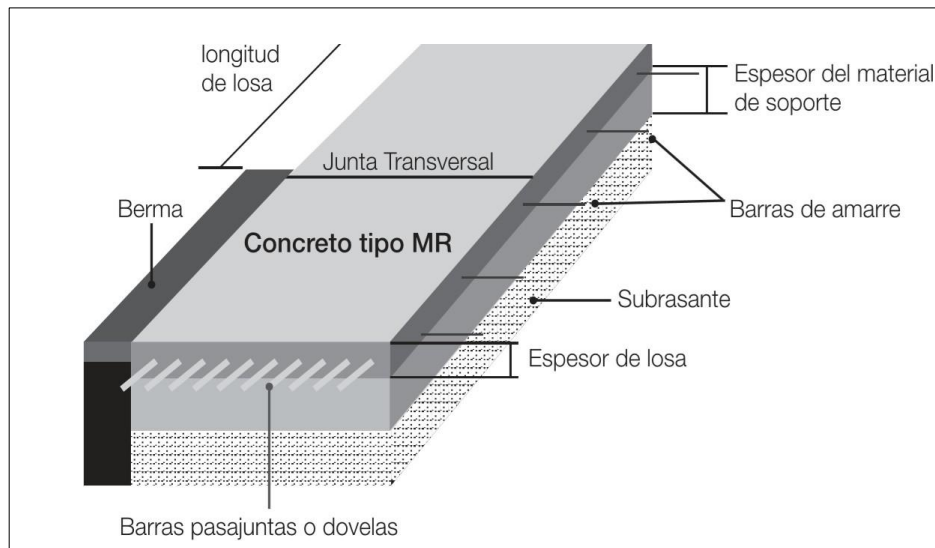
Esquema representativo de un pavimento de concreto.
